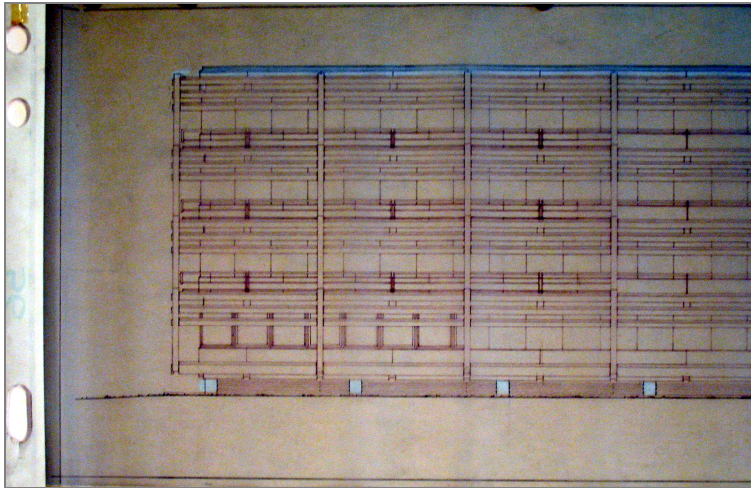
prospetto tipo (fonte CSAC – stralcio tav. 58, archivio n. 384-6)
